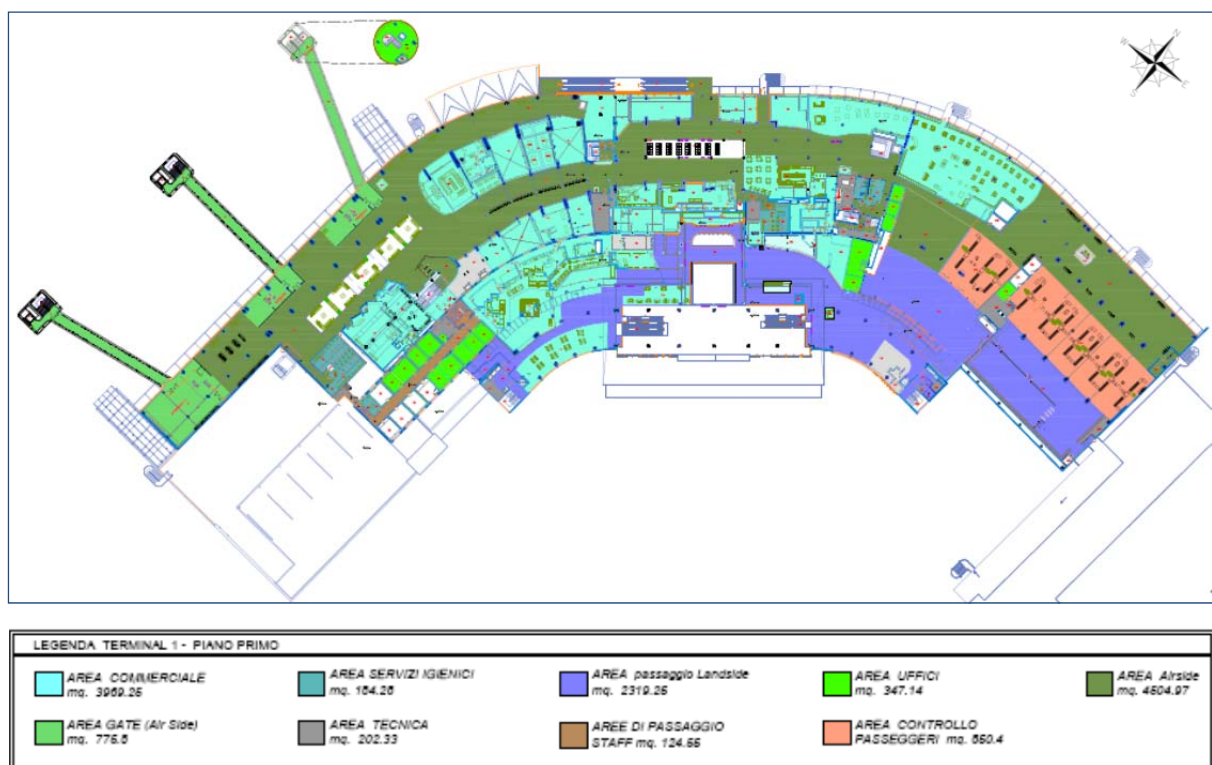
Terminal 1 – Pianta piano primo – Secondo livello funzionale
